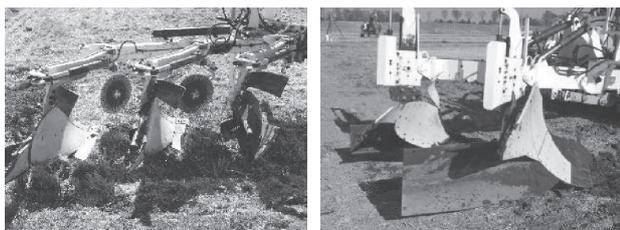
II-1 工法 3 連レーザープラウ 写真-6 II-2 工法 2 段階レーザープラウ
